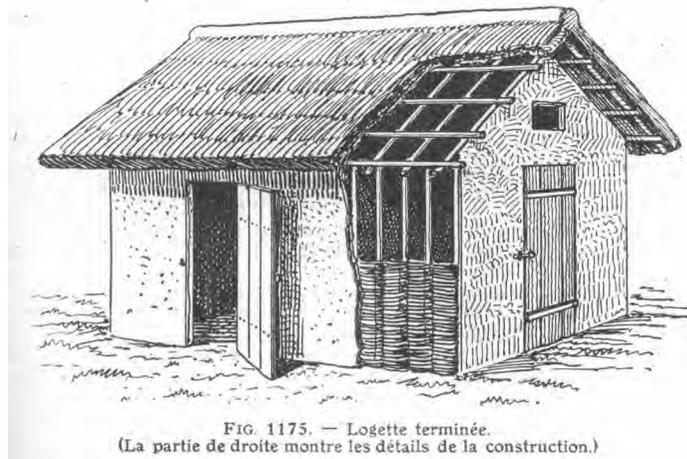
Logette terminée. (La partie de droite montre les détails de la construction.)
